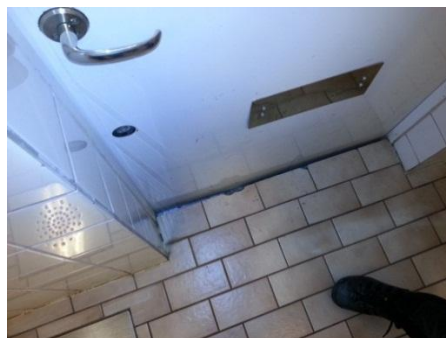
Dålig anslutning mellan dörr till ishallsdel och duschrumsgolv. Dörrnivån ligger under golvnivån och dessutom med en glipa emellan.
